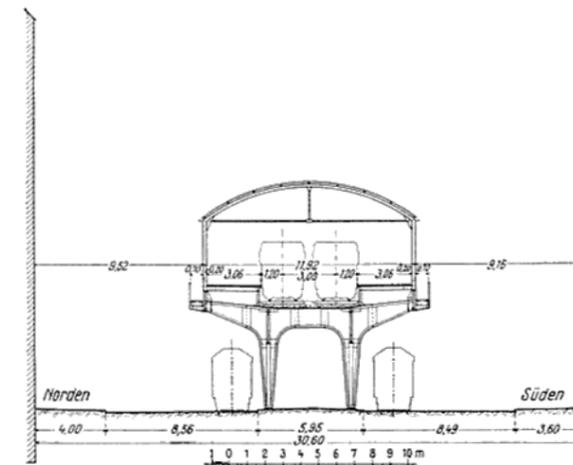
Gitschiner Straße mit Hochbahnhof Prinzenstraße.
